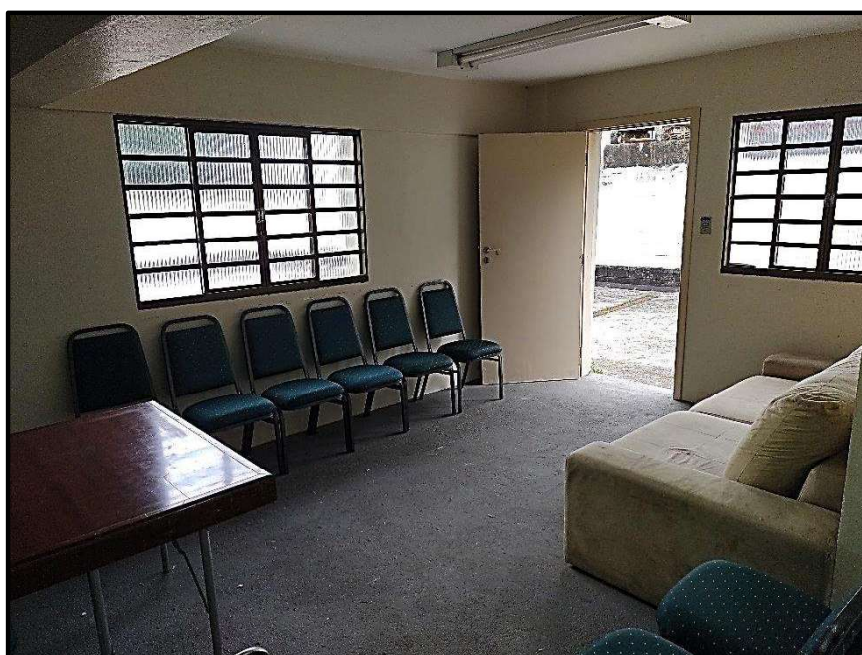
Aspecto interno de sala no pavimento inferior.
